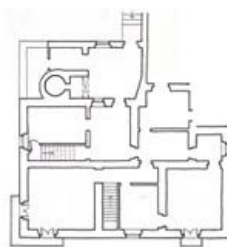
Casa urbana - Ponta Delgada (Açores)
